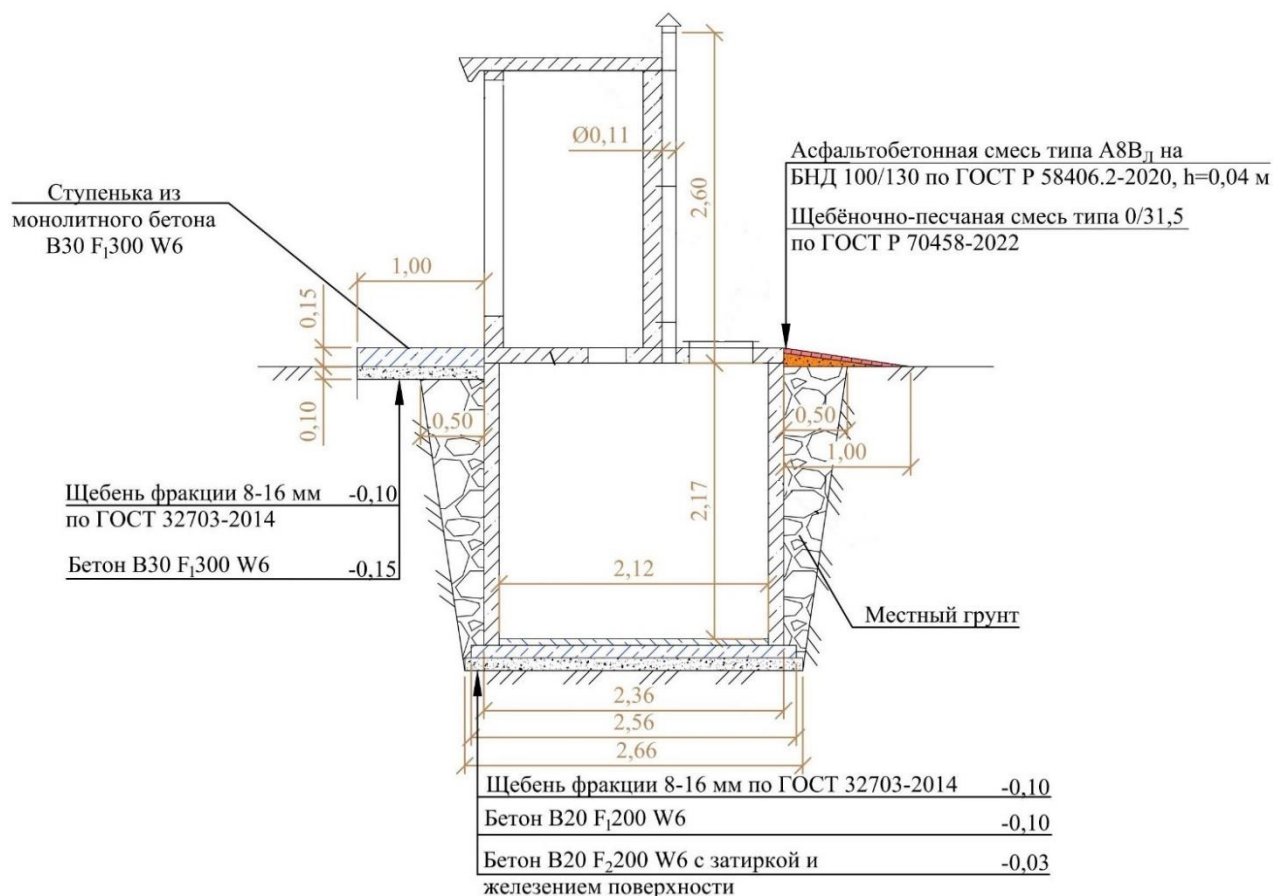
Туалет, выполненный из железобетонных конструкций
